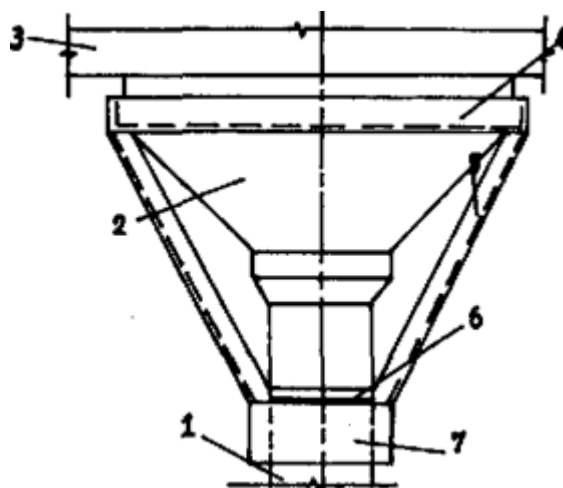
Усиление капителей безбалочных перекрытий: 1 - колонна; 2 - капитель; 3 - плита перекрытия; 4 - верхняя обвязка усиления; 5 - подкосы; 6 - нижняя обвязка усиления; 7 - обойма
